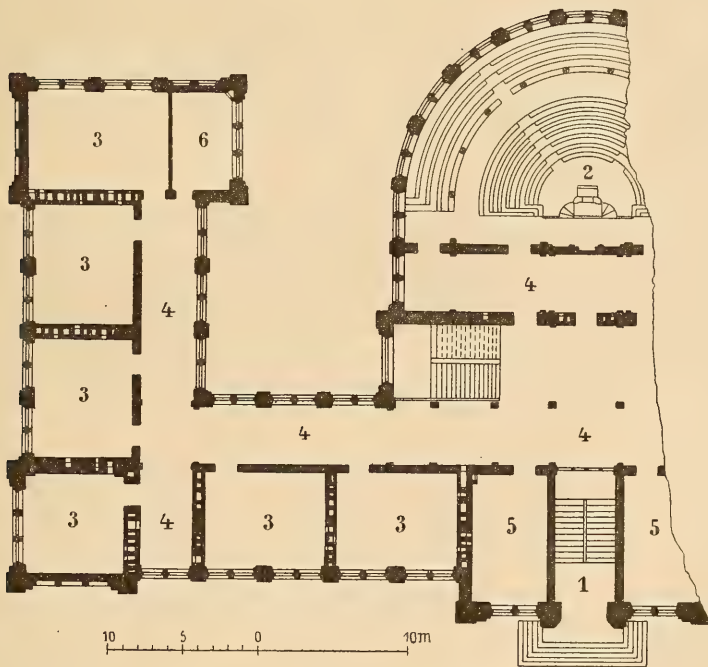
Oberrealschule in Stockholm. Grundriss des Halbstocks. Aus v. Friesen. 1 Eingang. 2 Betsaal. 3 Lehrzimmer. 4 Gänge mit den Kleiderablagen. 5 Frühstückszimmer. 6 Aufbewahrungsraum.
